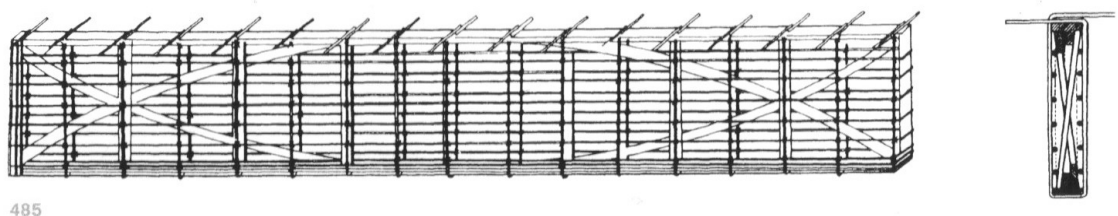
Diagrama da patente de uma viga de concreto armado de Joseph Monier. FONTE: ADDIS, 2009.
